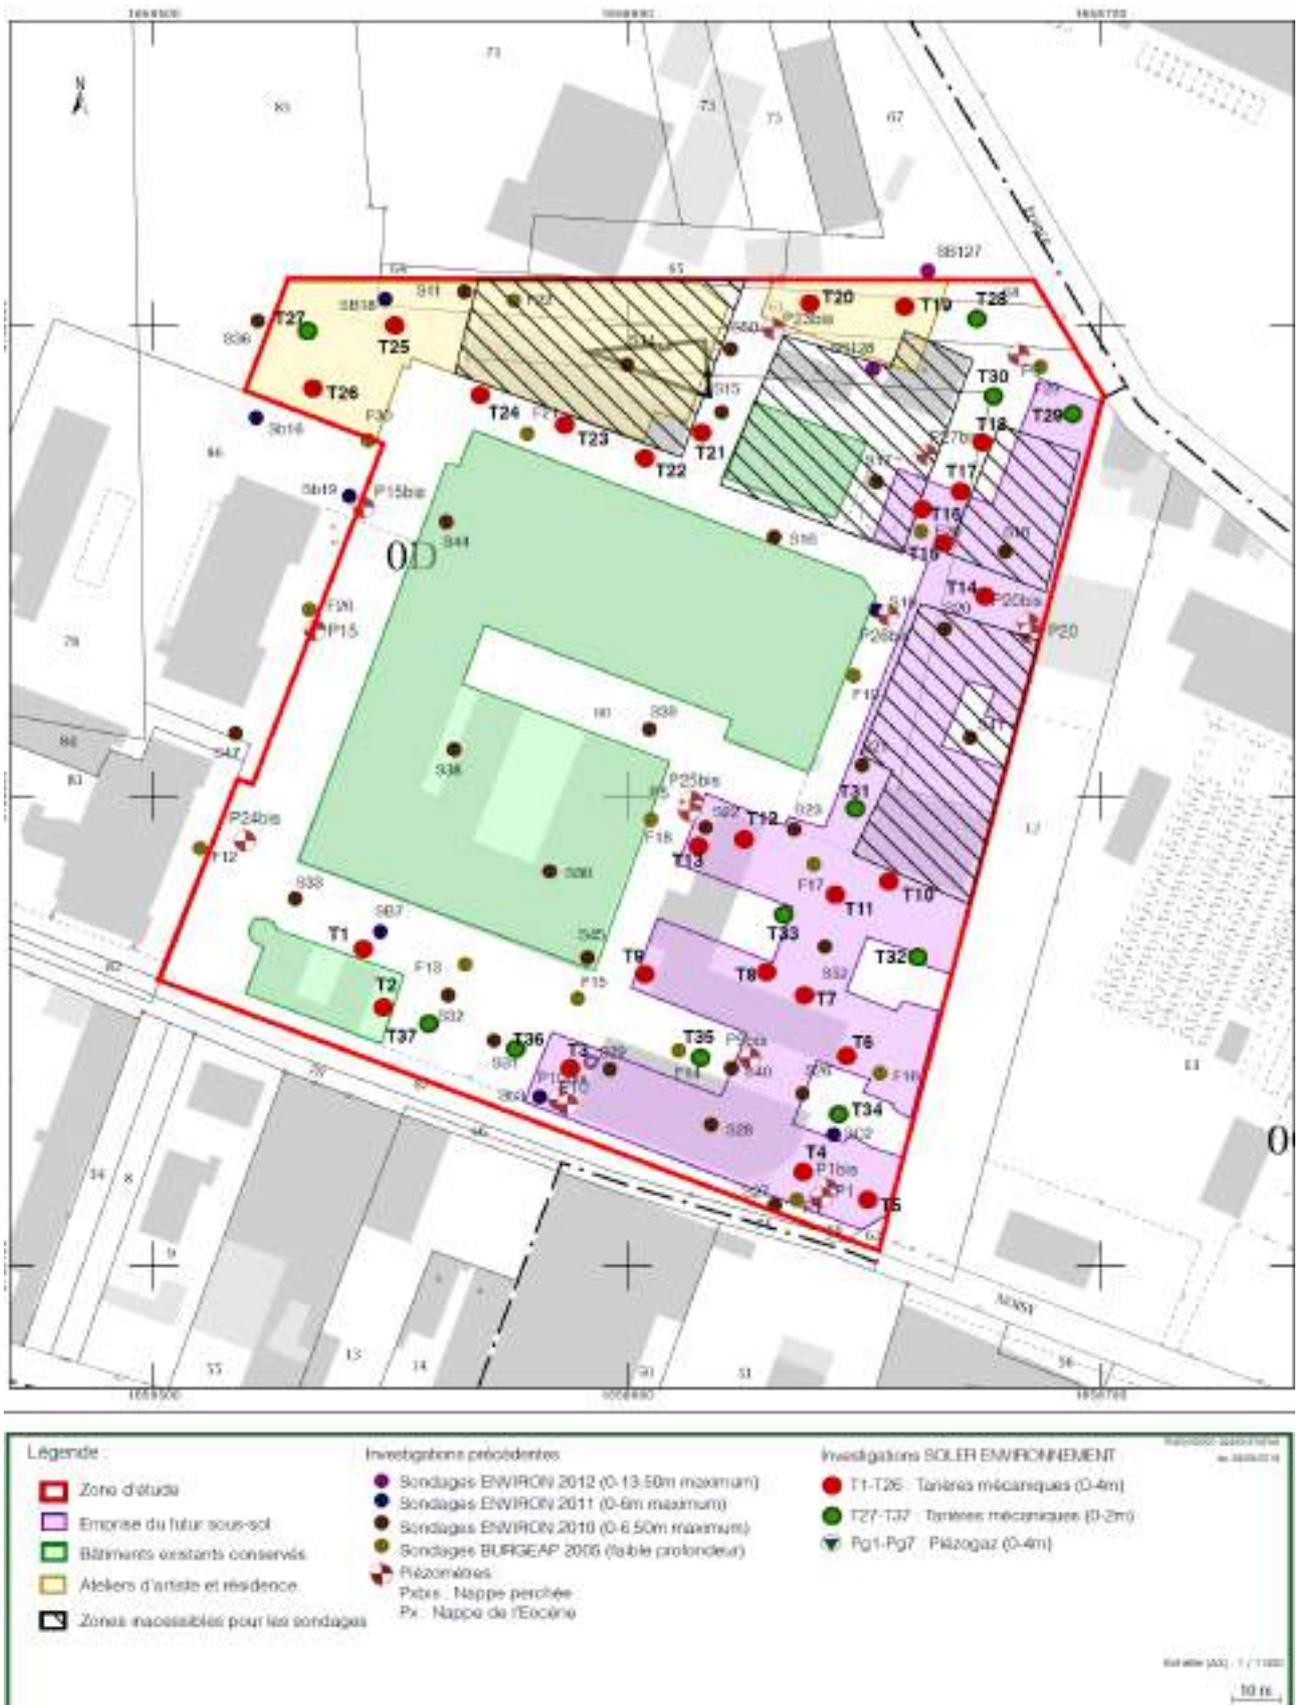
Plan d'implantation des sondages (source : Soler Environnement 2019)
